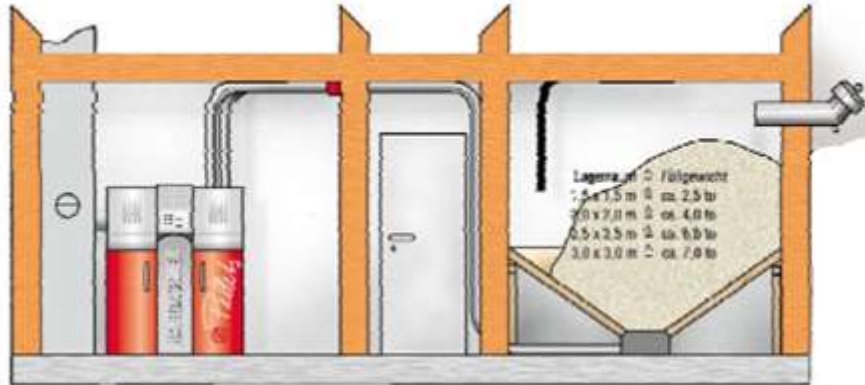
Silo provisto de suelo de madera plano e inclinado a 35° por ambos lados.
